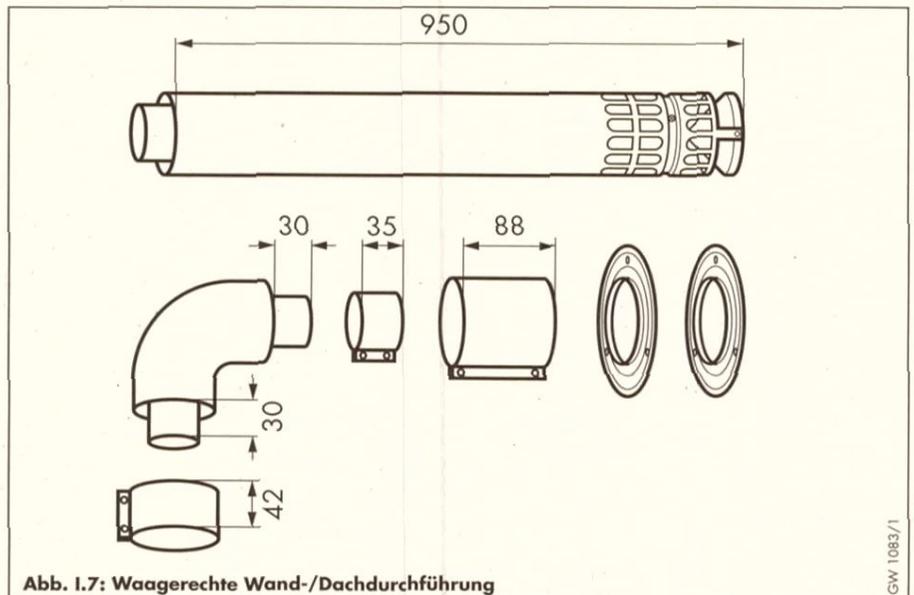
Waagerechte Wand-/Dachdurchführung
